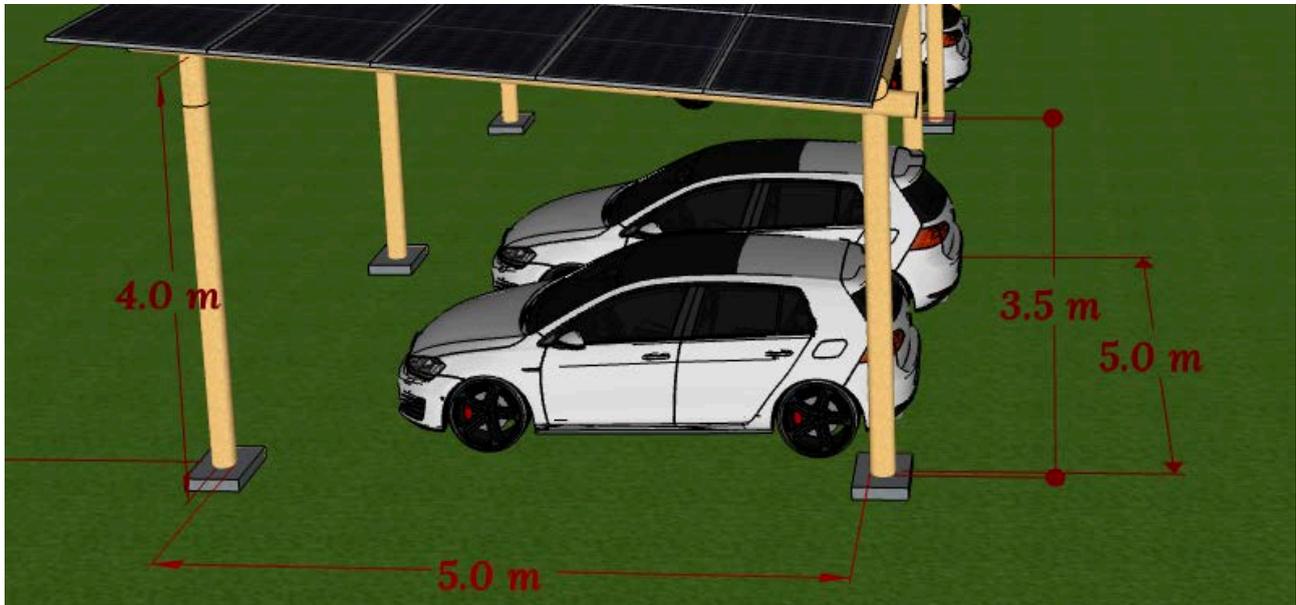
Simulação 3D do espaçamento entre pilares e suas dimensões(5,00x5,00).
